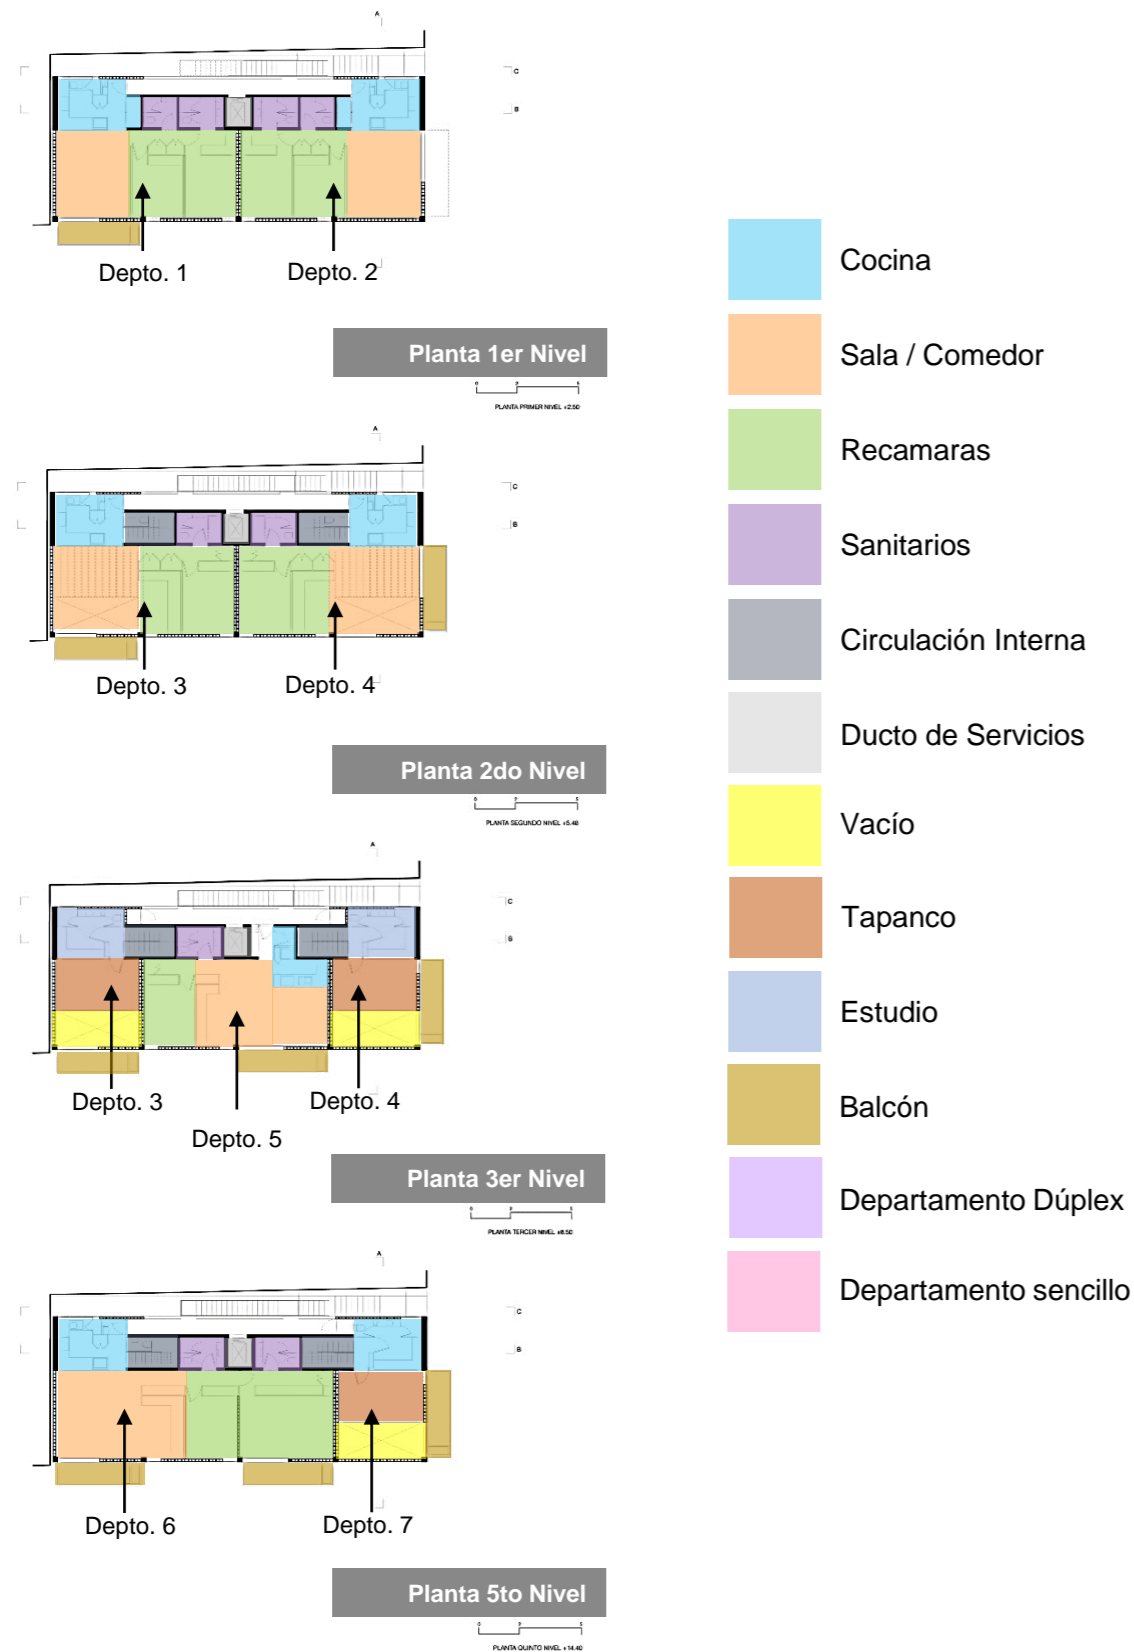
Plantas Arquitectónicas. (Edición Propia)
